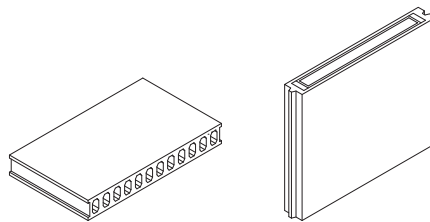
Placa alveolar de hormigón prefabricado y placa de hormigón prefabricado armado con aislante térmico.
